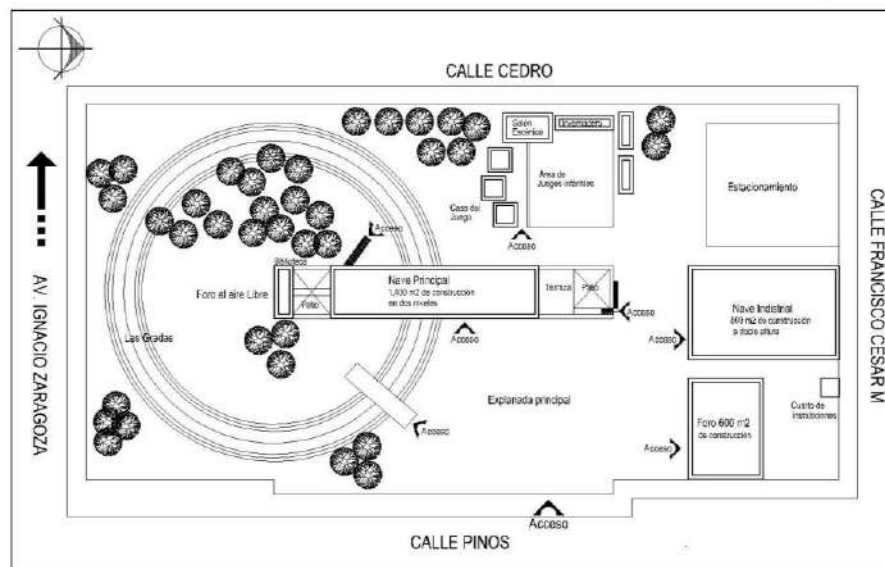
plano de conjunto del faro oriente creado por el Arquitecto Leonardo Ortiz¹¹⁸
